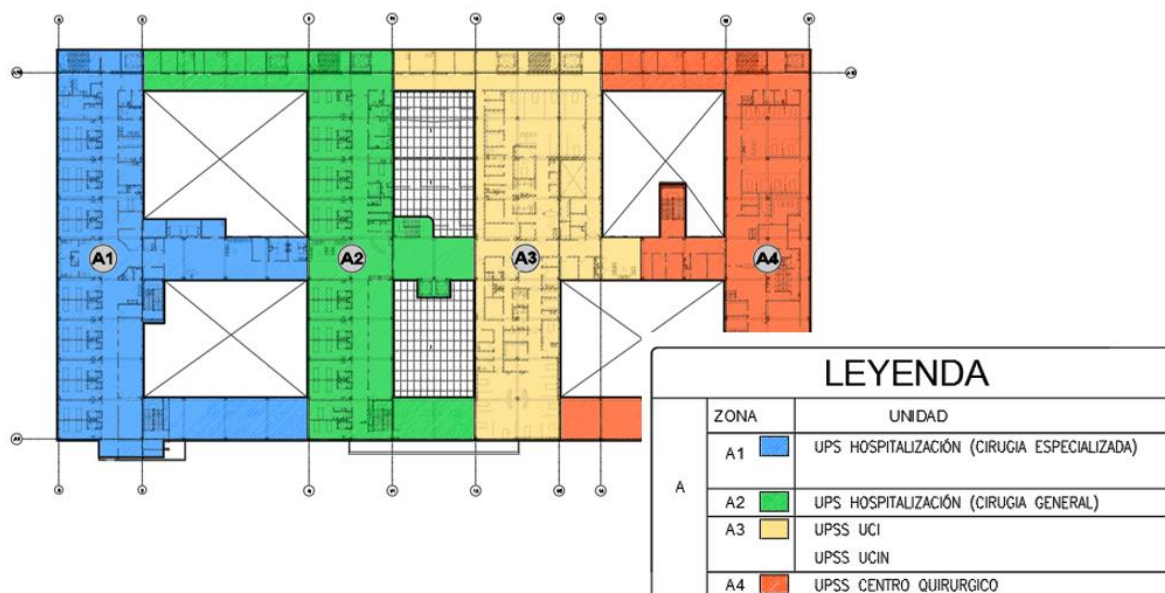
Plano de Planta con Sectorizaciones Tercer Nivel
